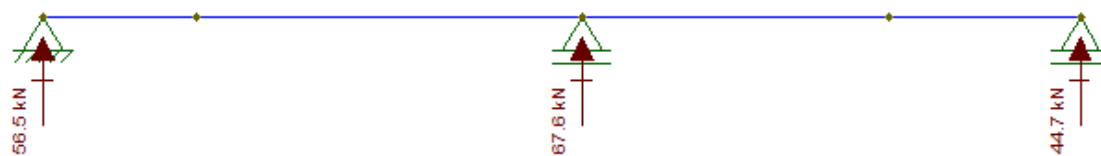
Reações de apoio - Viga 8 (a e b) (Tipo).
